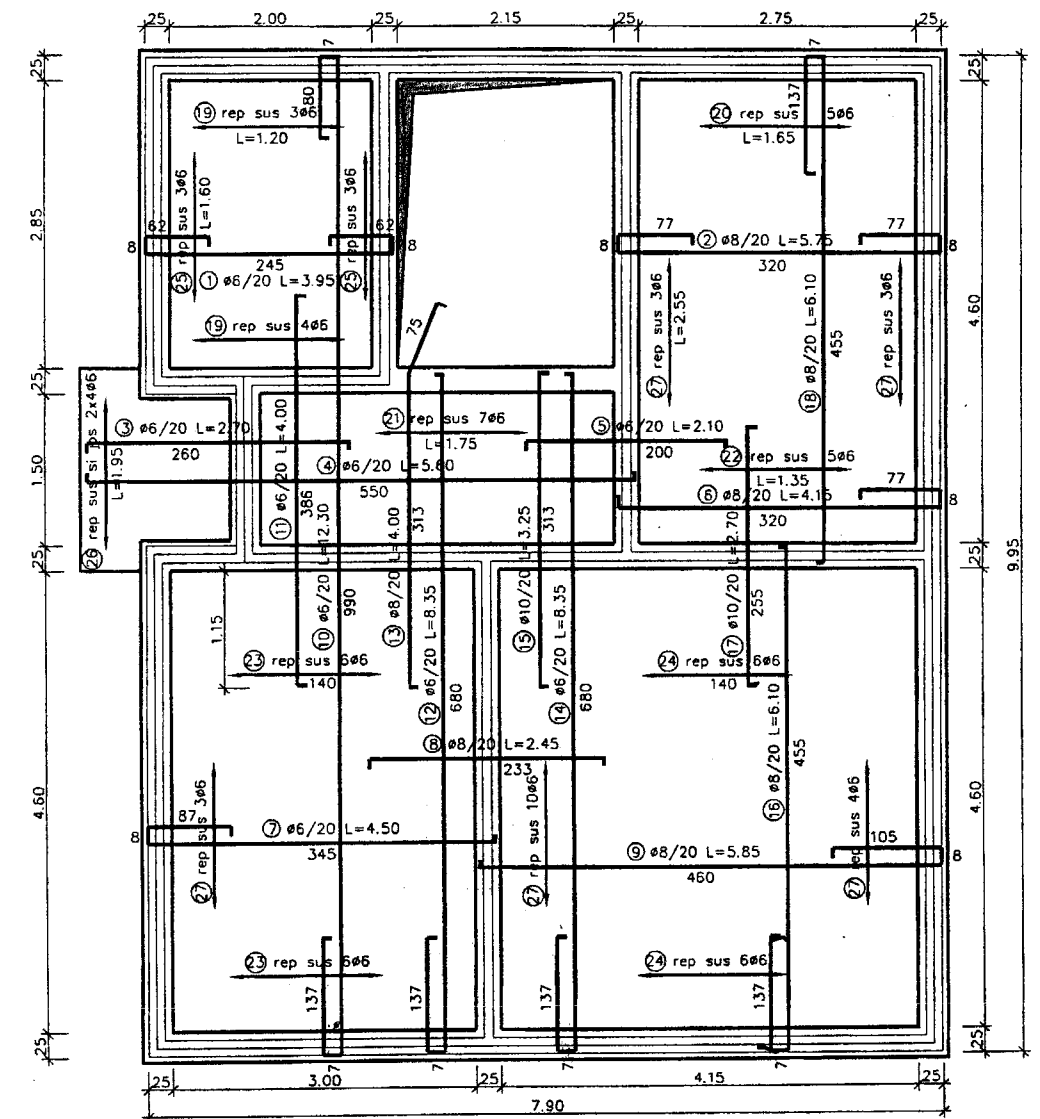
Plan cofraj și armare placă planșeu peste parter
